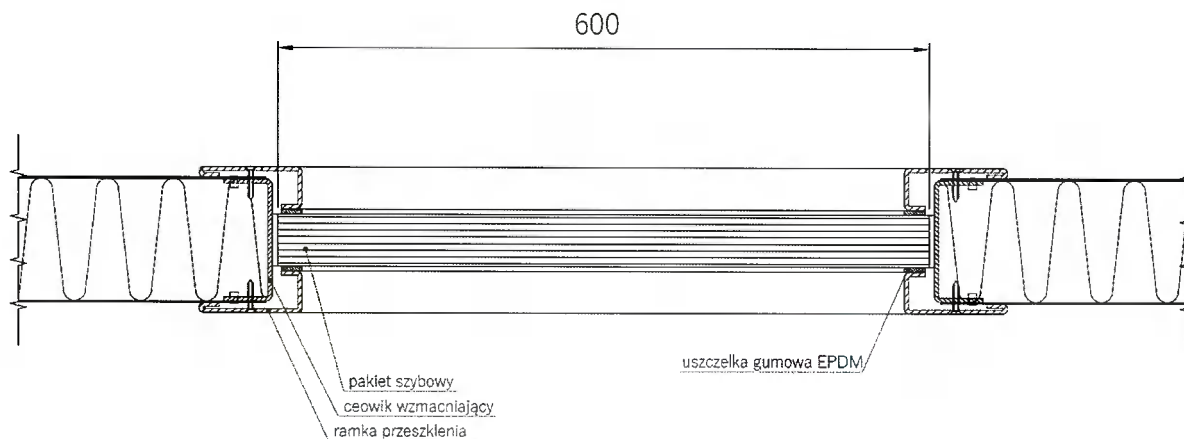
Stalowe drzwi wewnętrzne MULTIPLAY – przekrój pionowy
